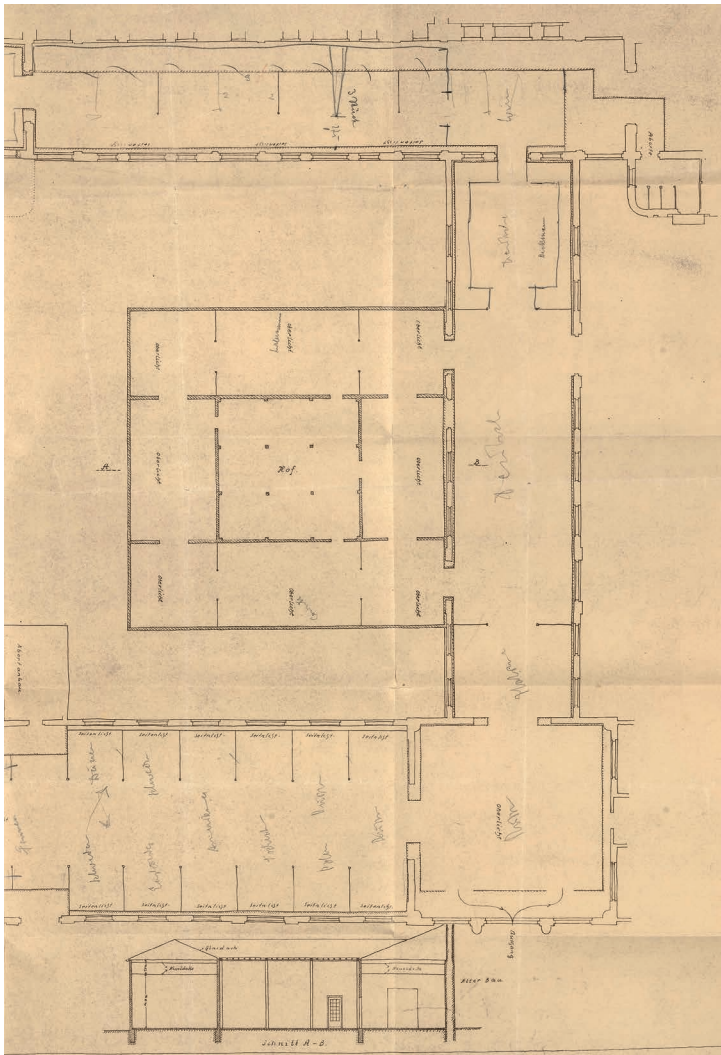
Grundriss des Städtischen Ausstellungspalastes (Ausschnitt), 1925/26, mit Darstellungen des Anbaus von Heinrich Tessenow; unten: Raumfolge 29 bis 31 im Schnitt
